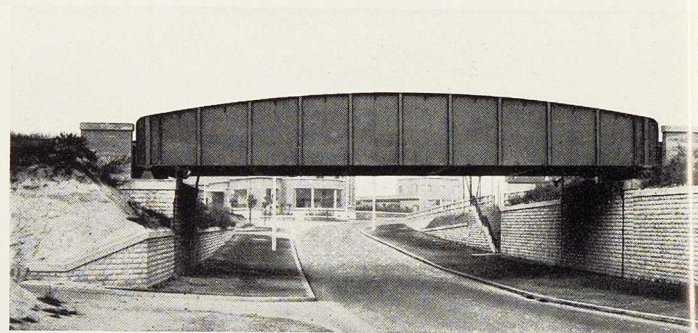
Pont sur le boulevard Ney à la Porte de la Chapelle à Paris. Joints de semelles en X avec brides triangulaires.
